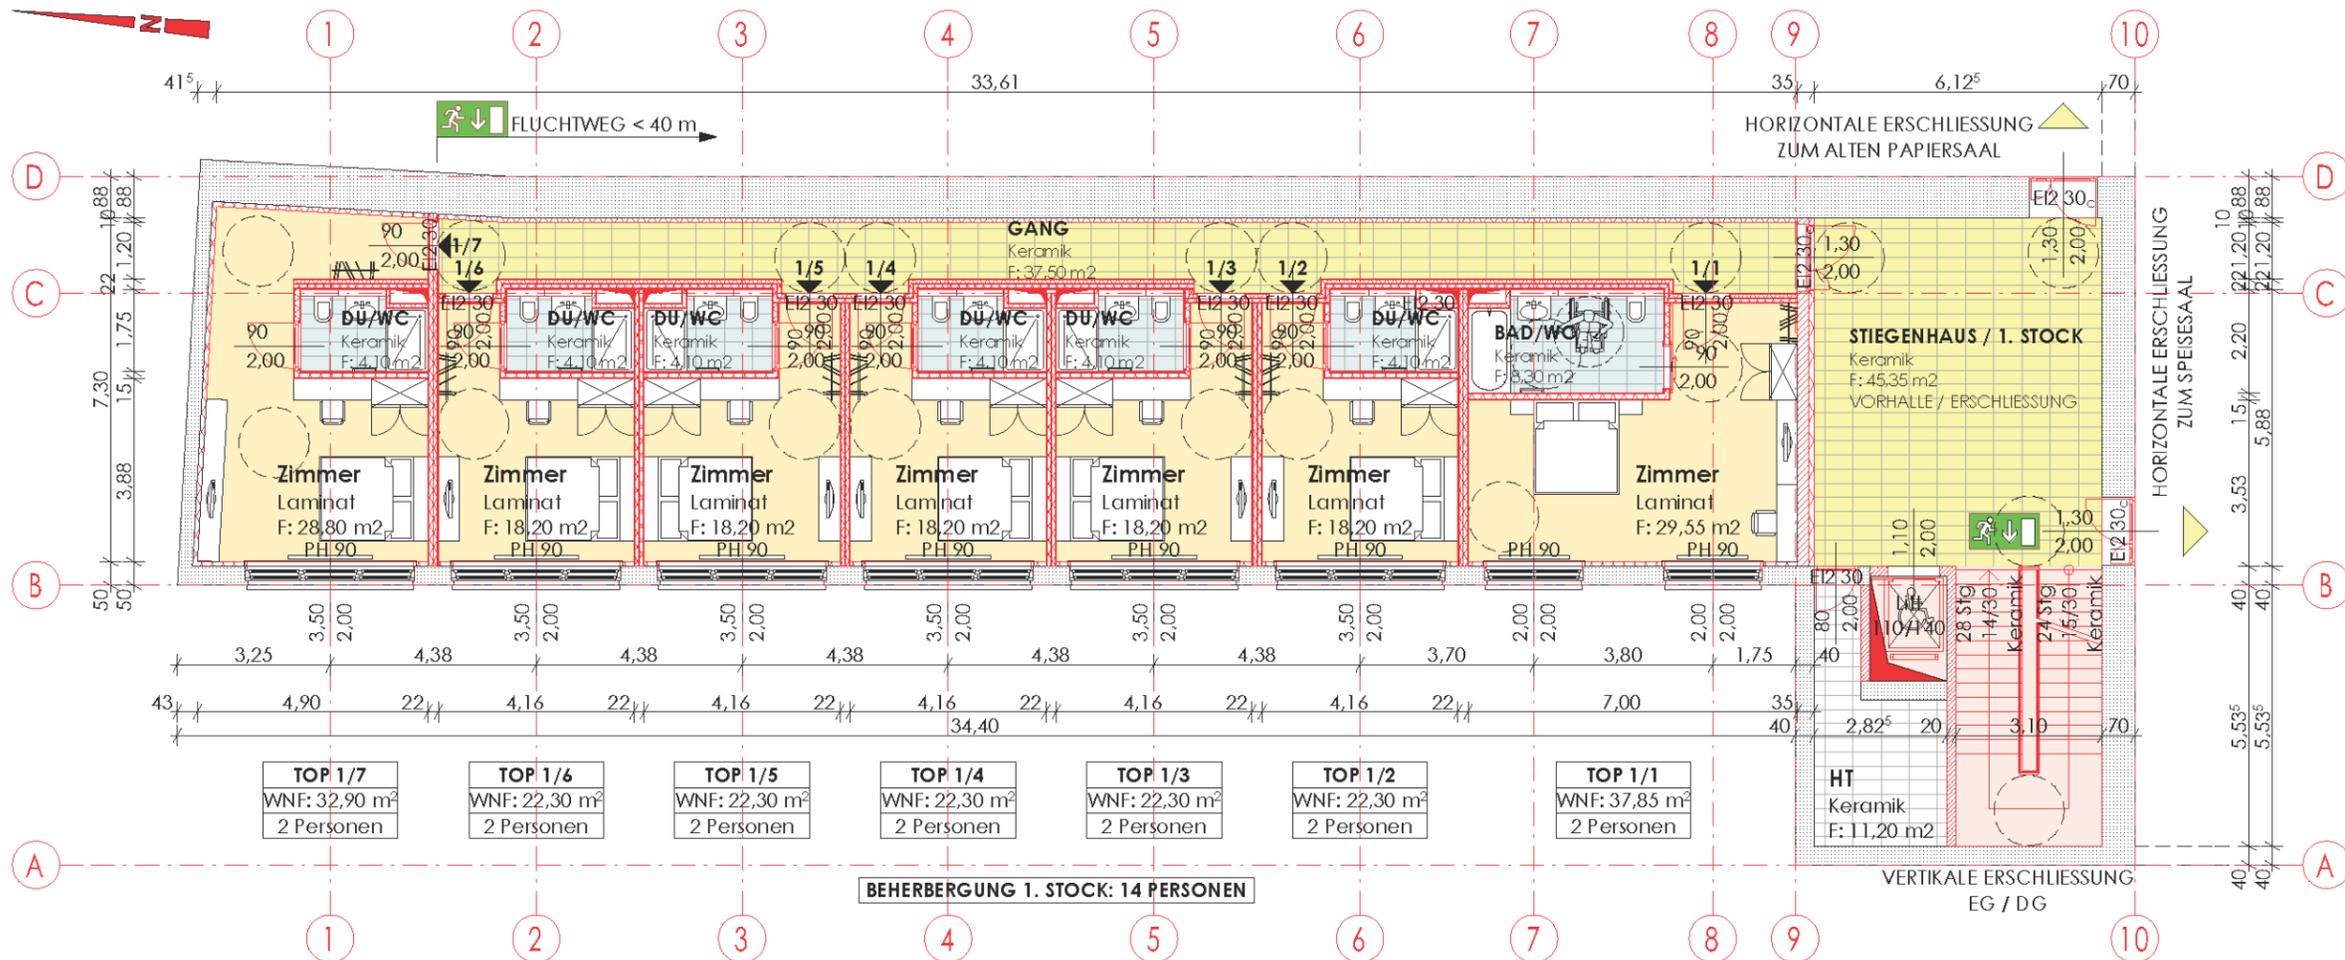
Grundriss Beherbergung 1. Stock / M 1:150
